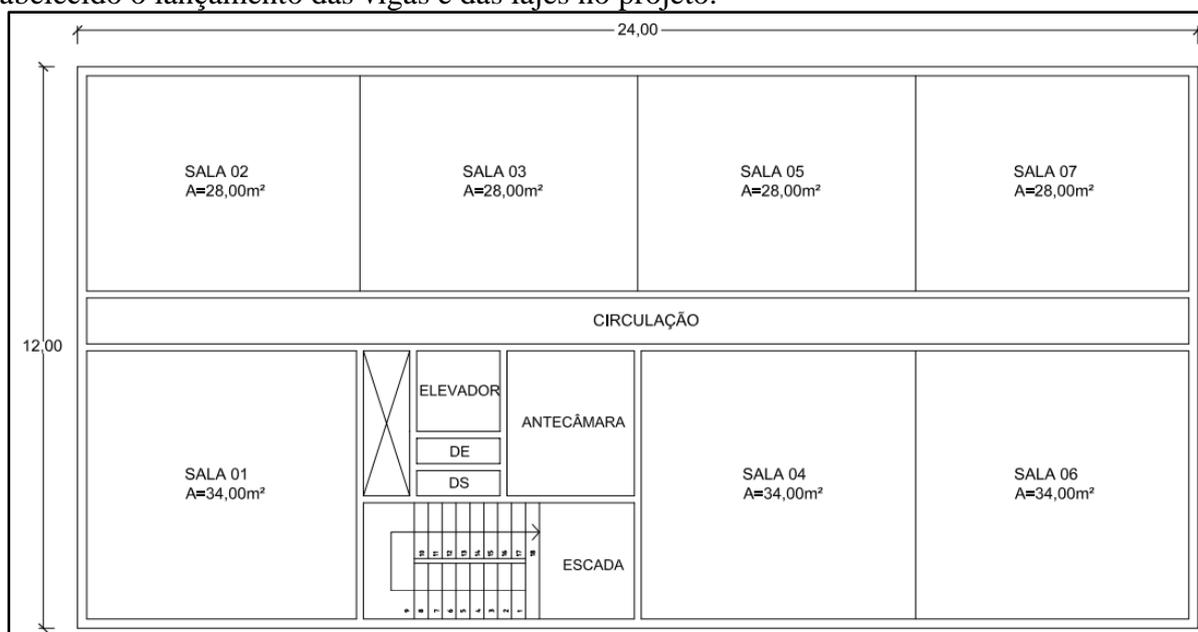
Desenho esquemático da planta baixa do pavimento tipo.
